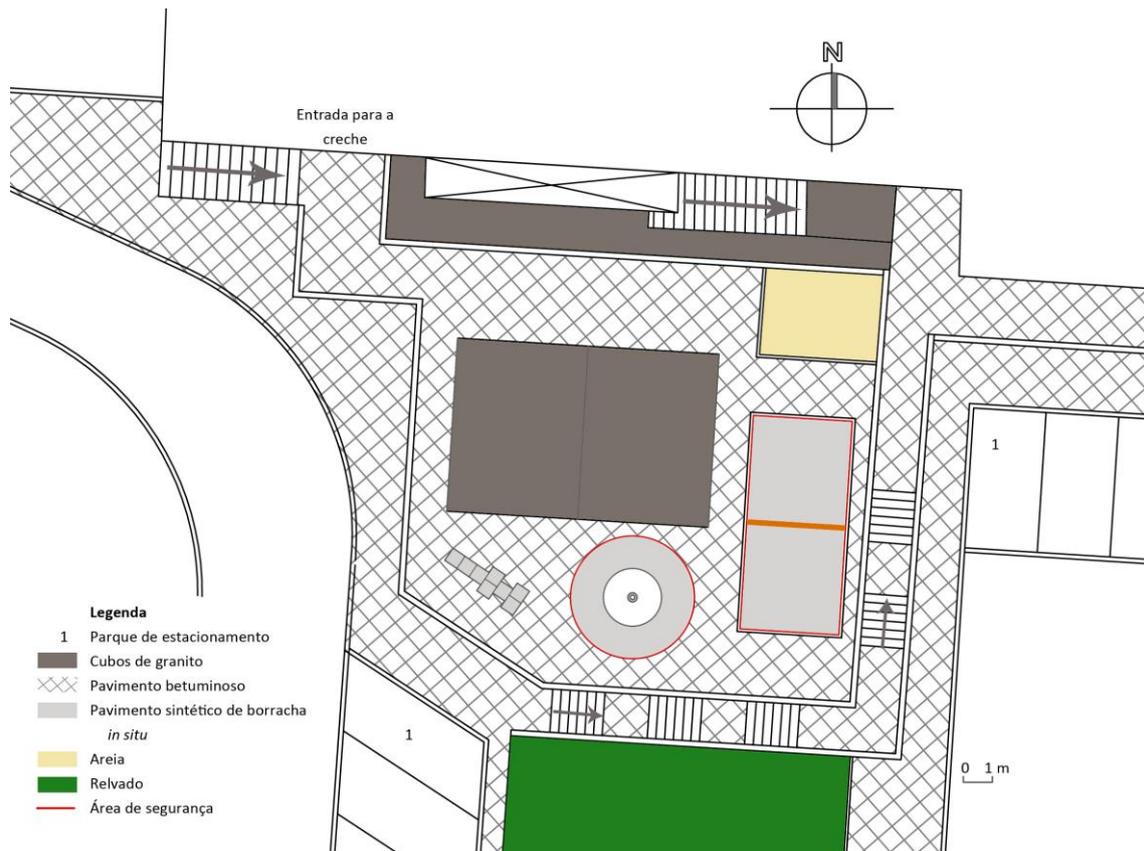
Planta geral final da proposta de intervenção do espaço de recreio. (Planta elaborada pela autora)
